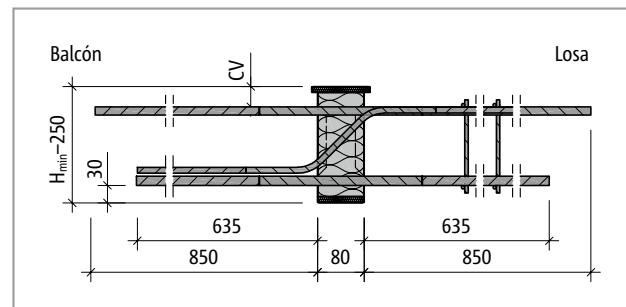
Schöck Isokorb® T tipo K-M13 hasta M14: Sección del producto
